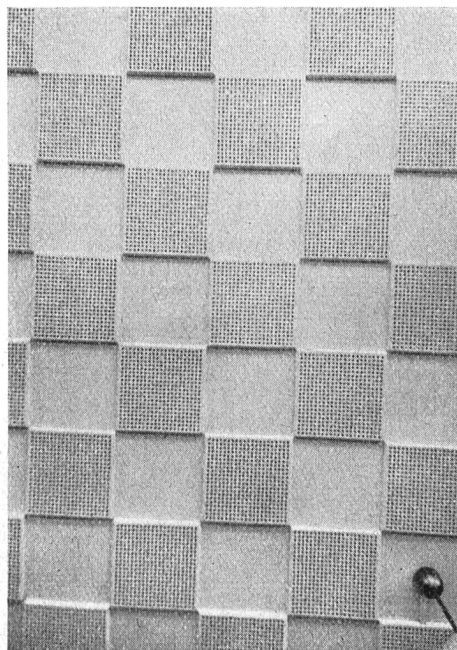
Detail der Deckenverkleidung, Installationsbureau Zürich. Revêtement du plafond, bureau des installations, Zurich.
